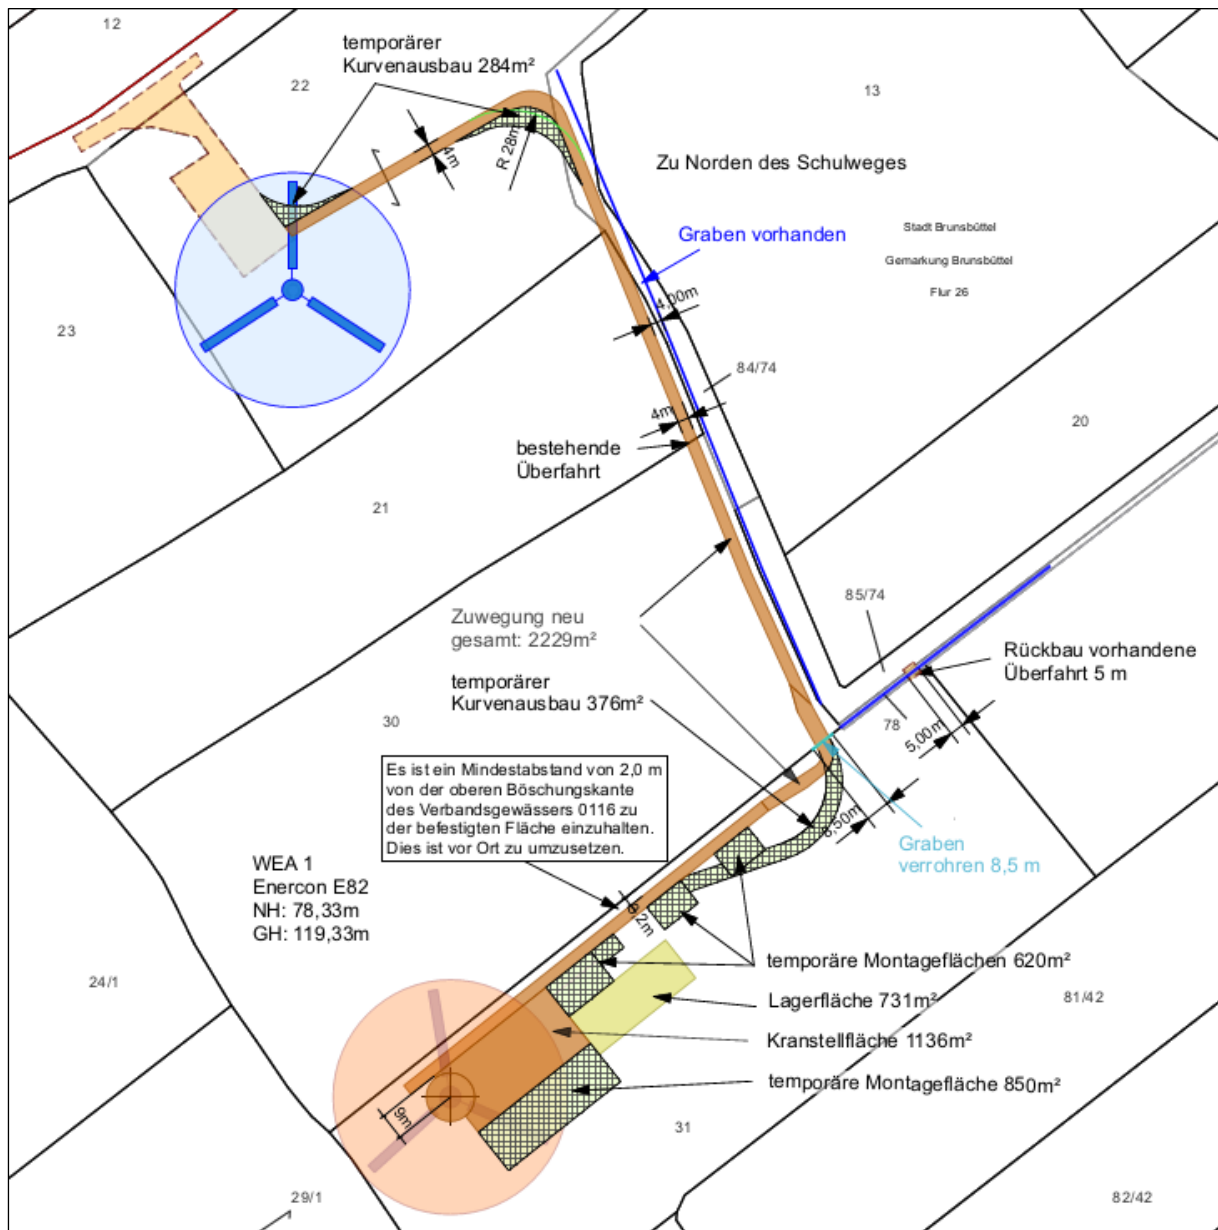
Planausschnitt Zuwegung mit Flächenangaben
